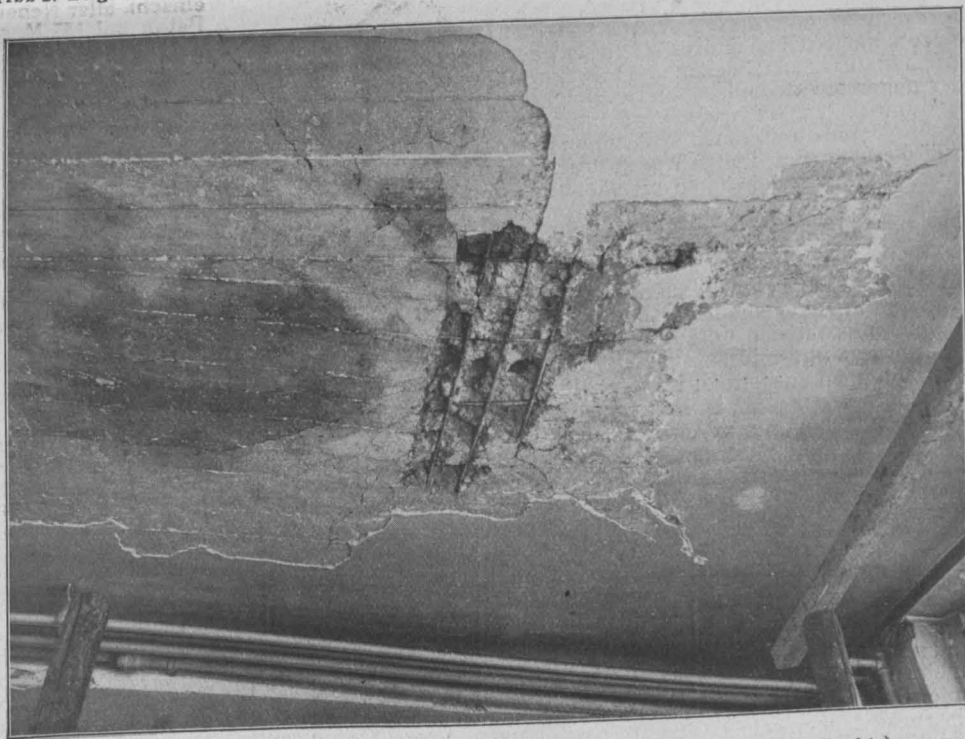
Untersicht der Decke mit Anschluß an die Fassaden-Mauer (rechts).
